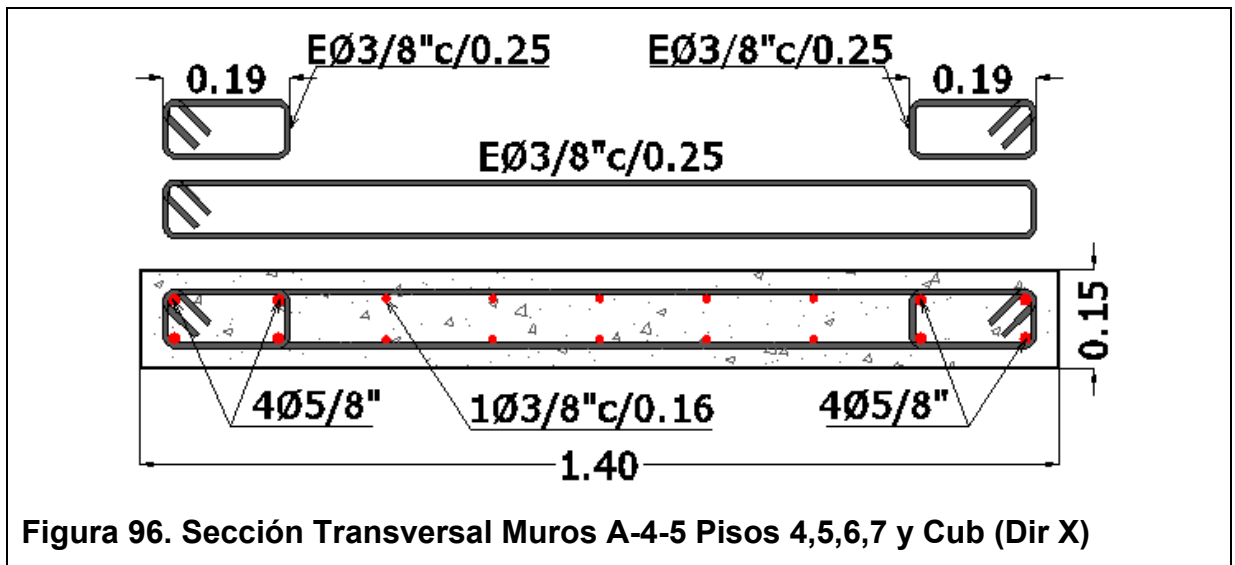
Sección Transversal Muros A-4-5 Pisos 4,5,6,7 y Cub (Dir X)
